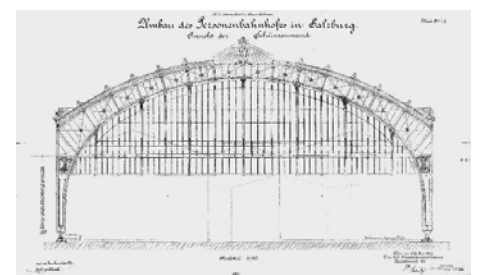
Plan eines Schürzenbinders des Hauptbahnhof Salzburg von 1907 [Quelle ÖBB]
